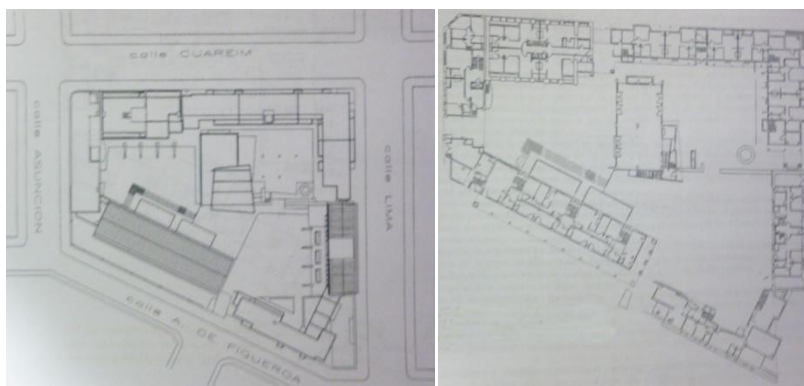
, 48: (de izq a der) Planta de la Antigua Cervecería de Uruguay / Distribución en planta de la propuesta para uso residencial. En: *La otra arquitectura: ciudad, vivienda y patrimonio*. Pág 131-132.
